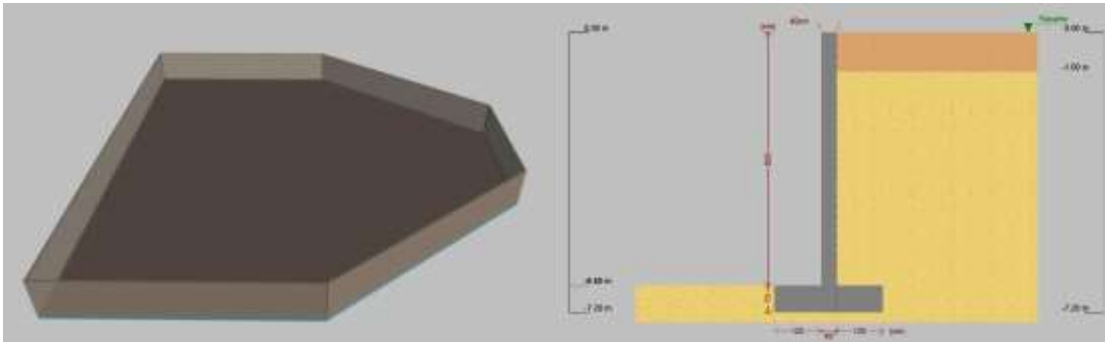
Balsa 2 de aguas pluviales, Alternativa 1 y Alternativa 2.
